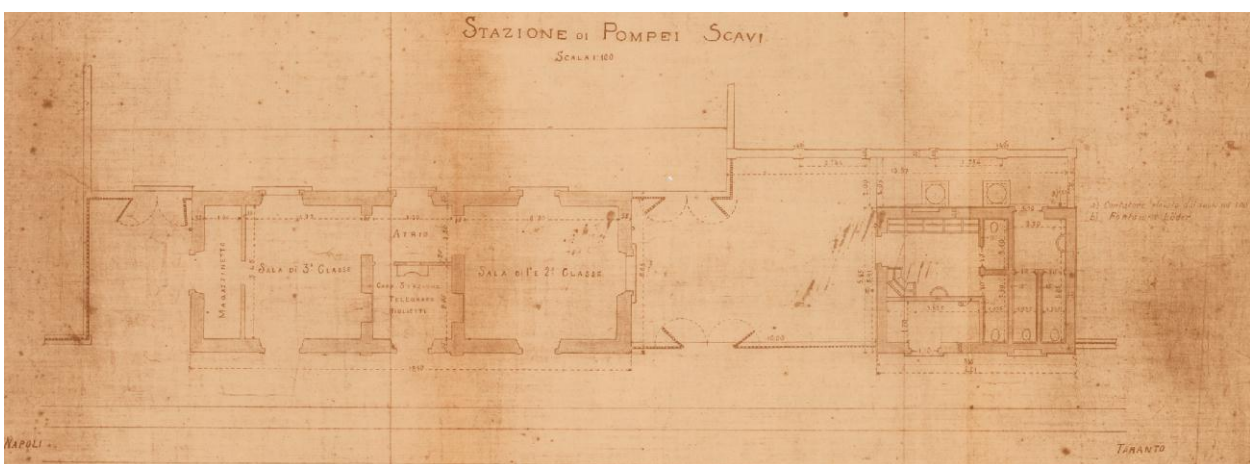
planimetria dei fabbricati della Ex fermata di Pompei scavi - fonte archivio storico FS
